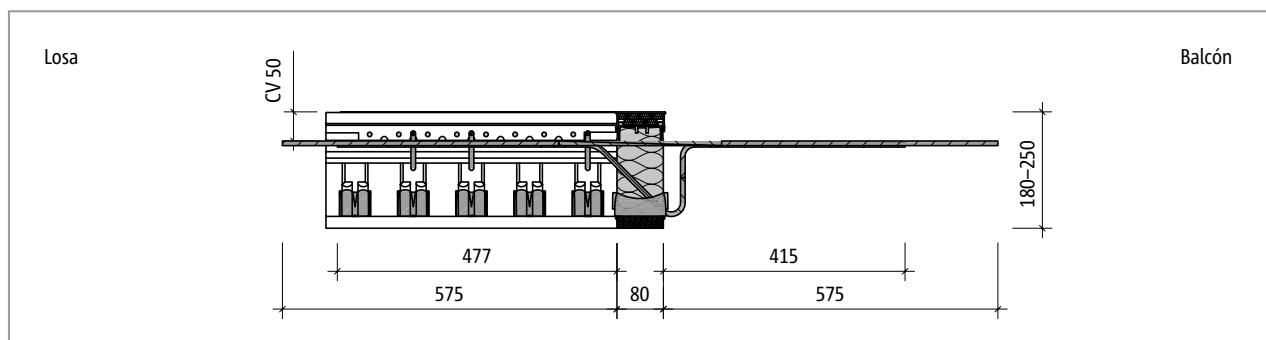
Schöck Isokorb® T tipo C-M1: Sección del producto
